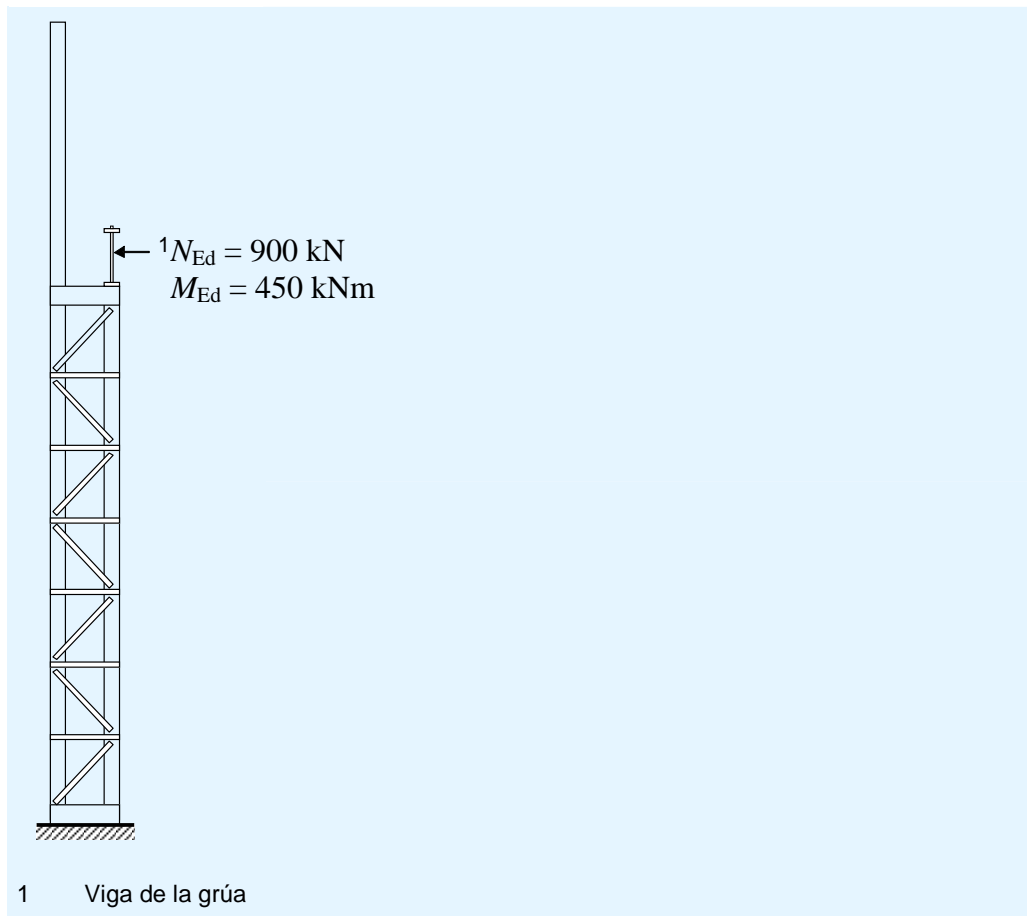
Pilar compuesto soportando la carrilera de un puente grúa
